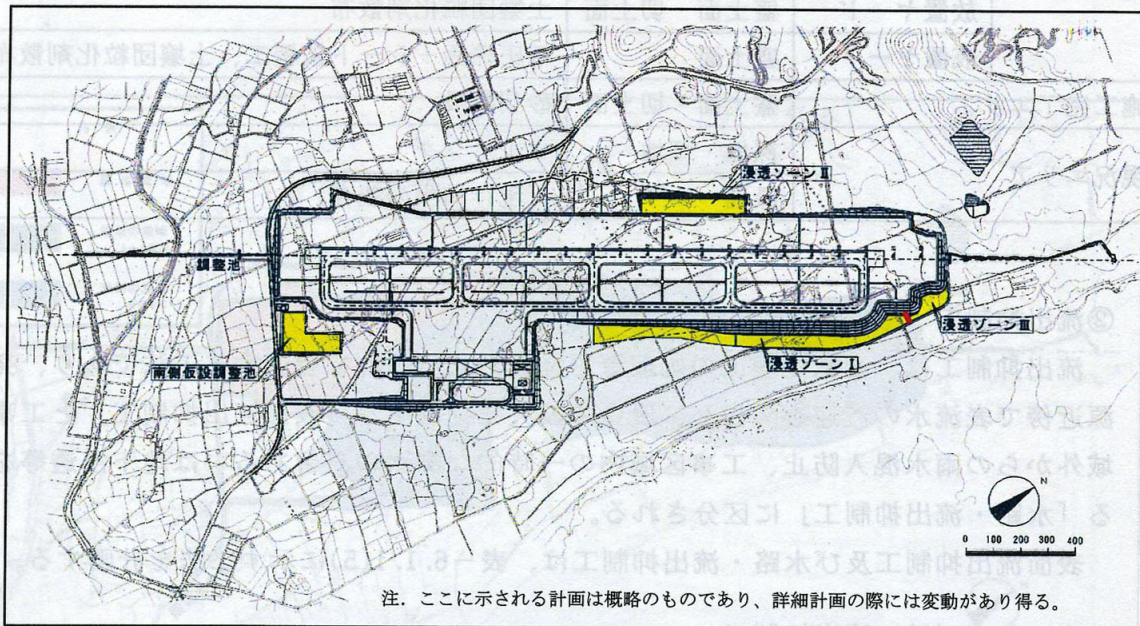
(7) 浸透ゾーン及び南側仮設調整池位置平面図
